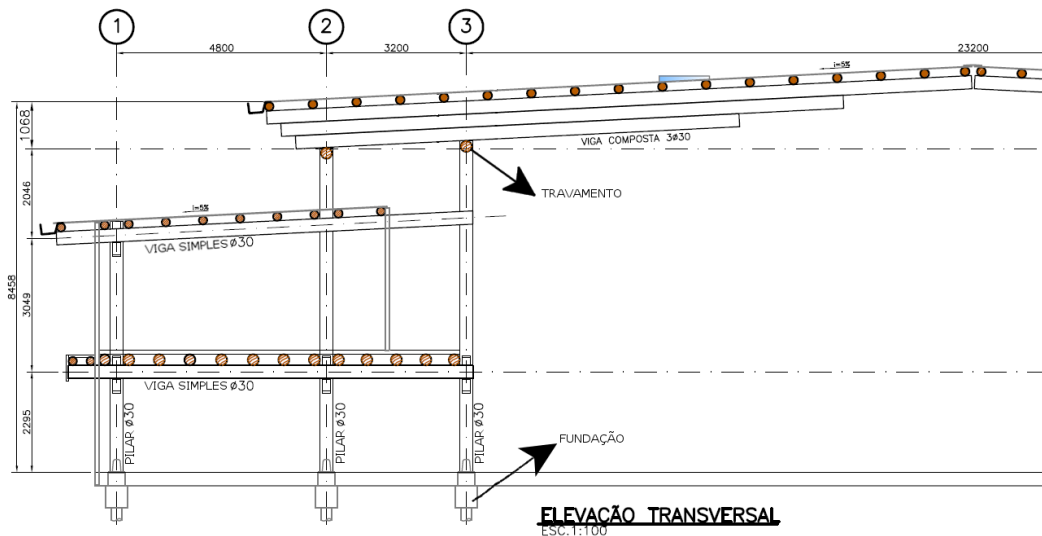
Desenho do módulo básico do pórtico retirado da planta disponibilizada.
